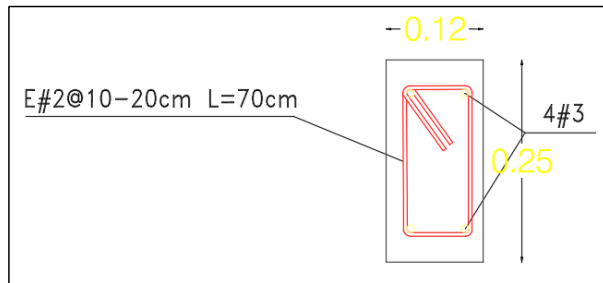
Sección transversal columneta de confinamiento.
